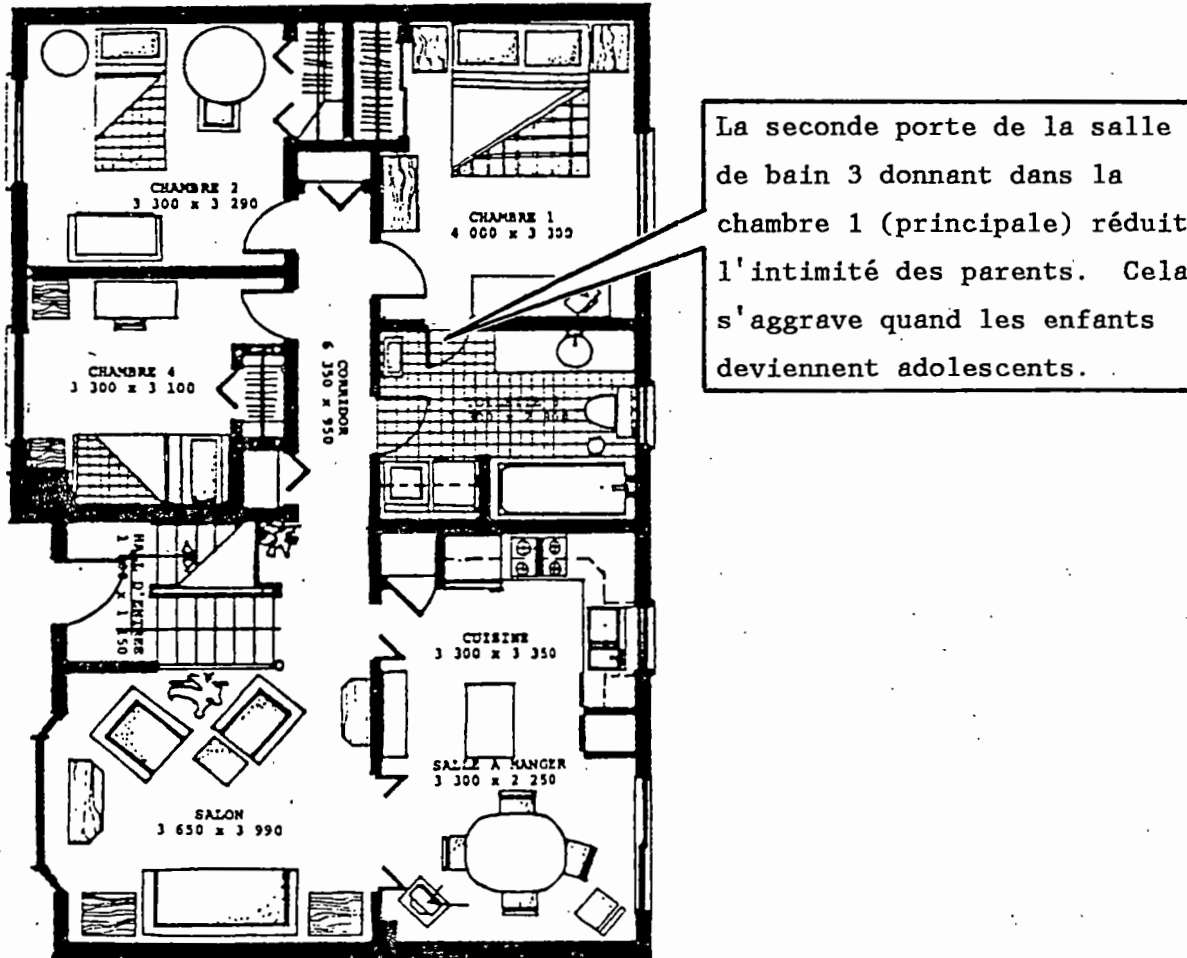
Plan du rez-de-chaussée d'un bungalow, Famille 13 (1371).
